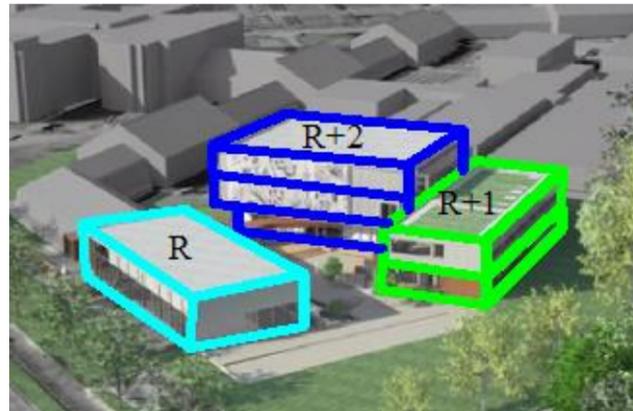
vue sur les trois bâtiments du projet. Source : vidéo du vimeo : <https://vimeo.com/80895973>:
